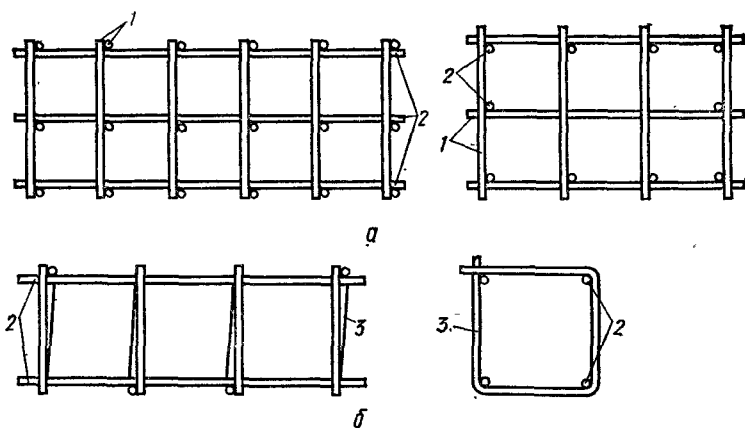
Арматурные каркасы, образованные напизыванием на продольные стержни заранее изготовленной поперечной арматуры:
